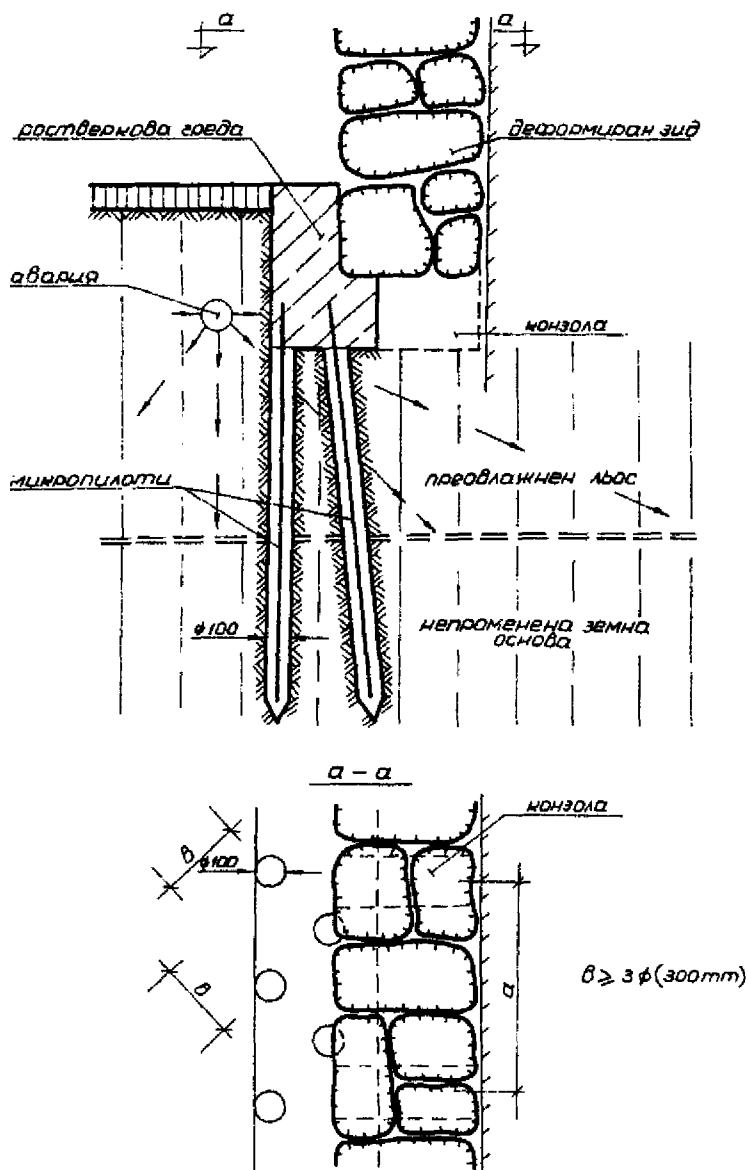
Укрепване на земна основа и фундаменти посредством система от микропилоти при двустранно третиране
